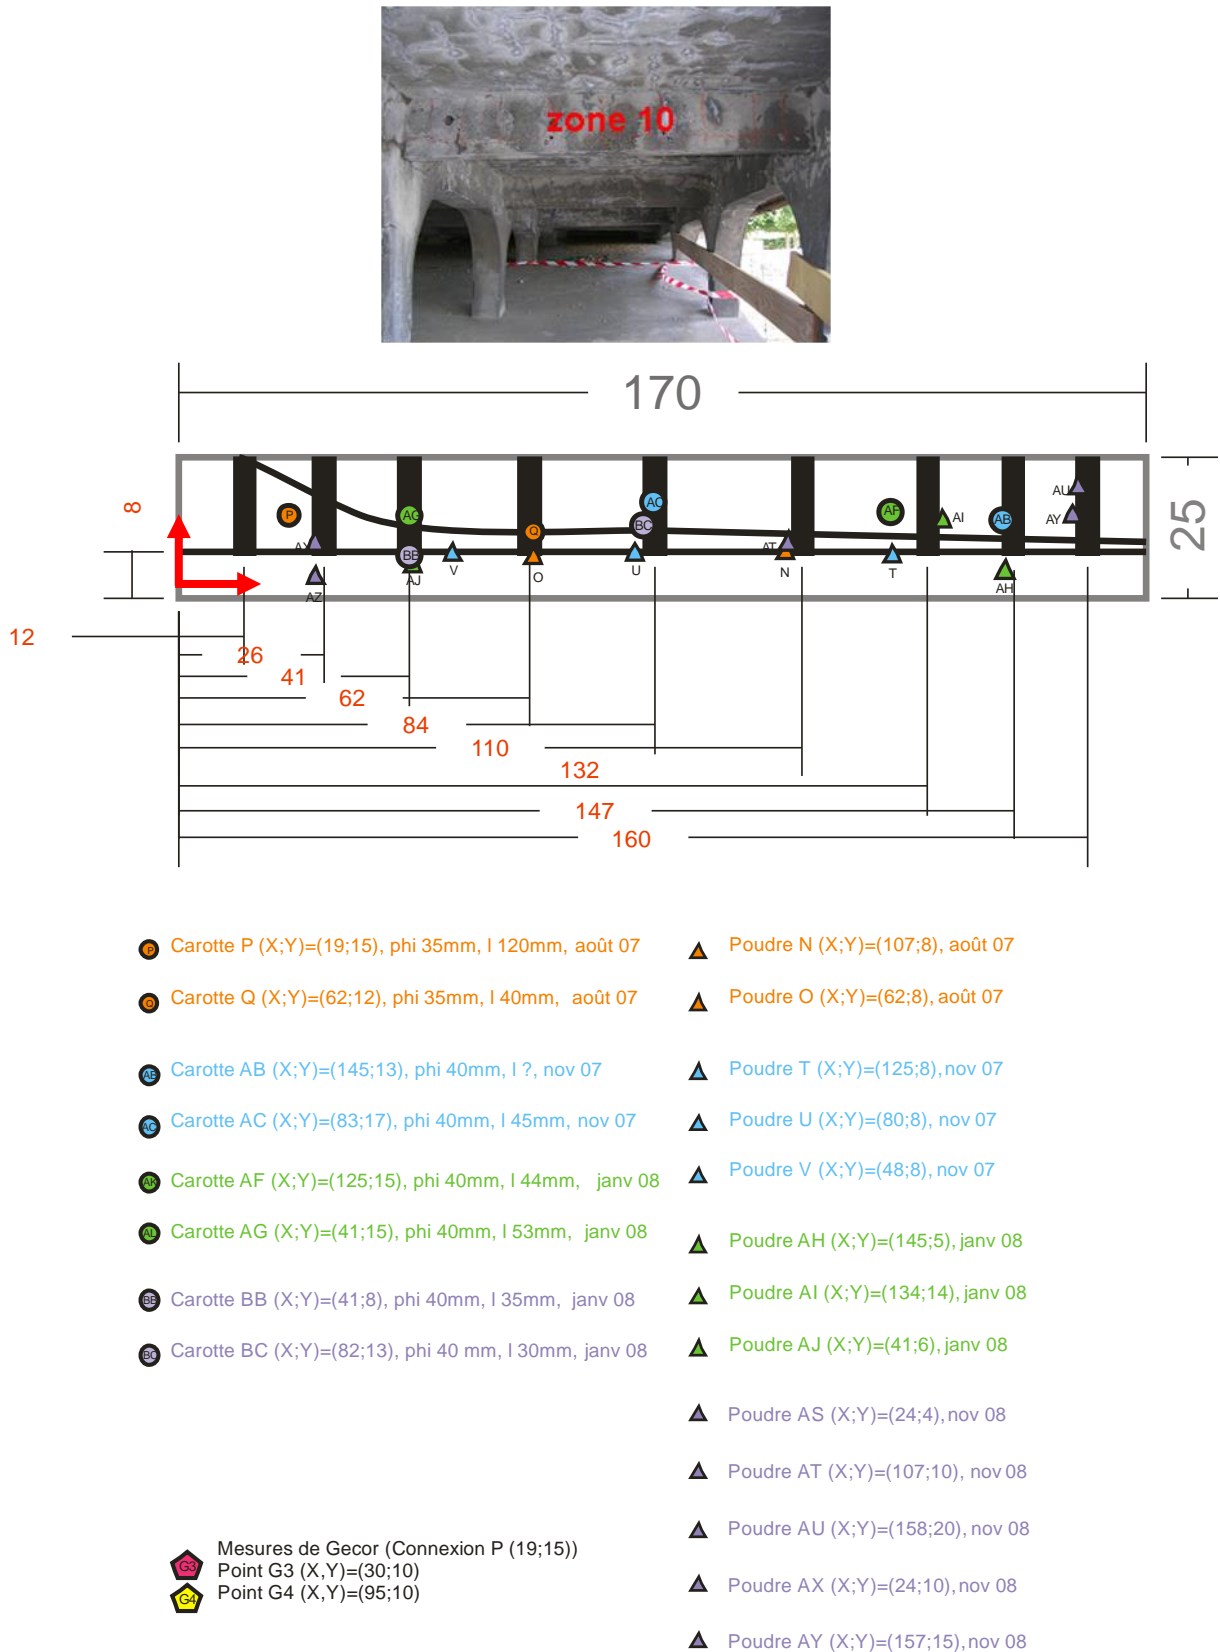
Zone 10. Photo et plan de ferrailage avec la localisation des prélèvements et des points de mesures.
